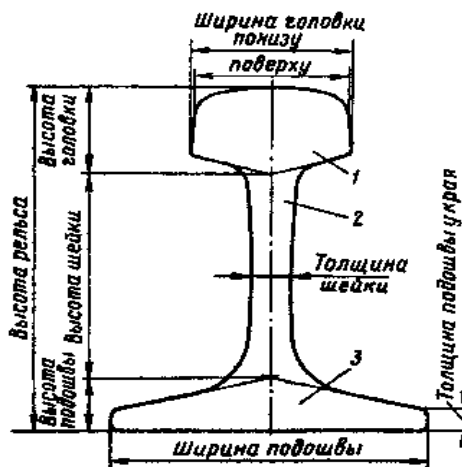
Профіль рейки: 1 – головка рейки; 2 – шийки; 3 – підшва
